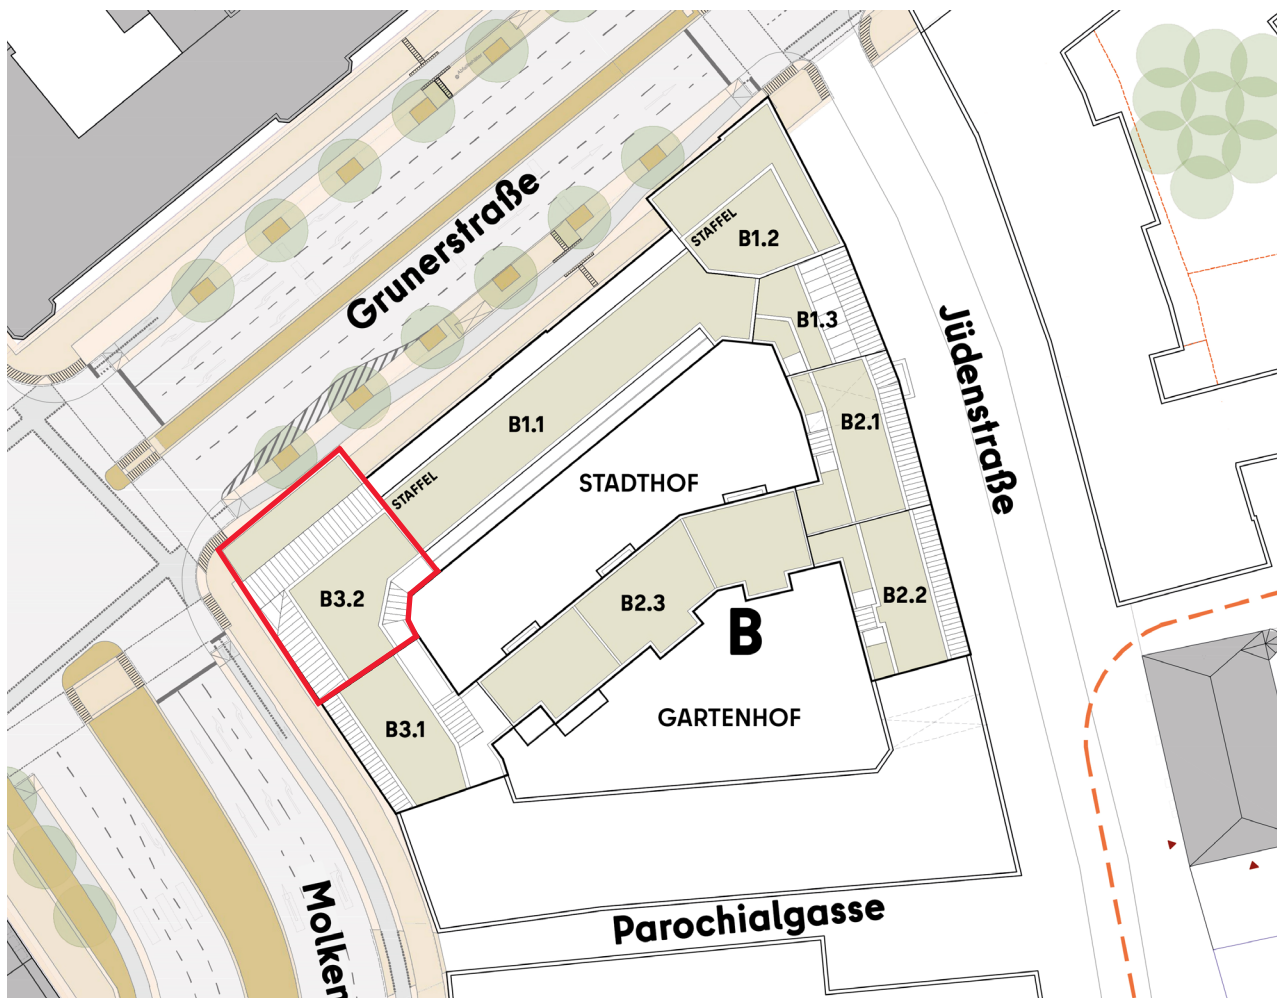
Dachaufsicht Block B mit Lage Haus B 3.2
